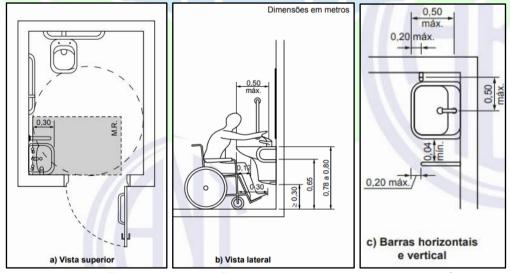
Dimensões para instalação das barras de apoio para lavatório conforme NBR 9050/2020.
